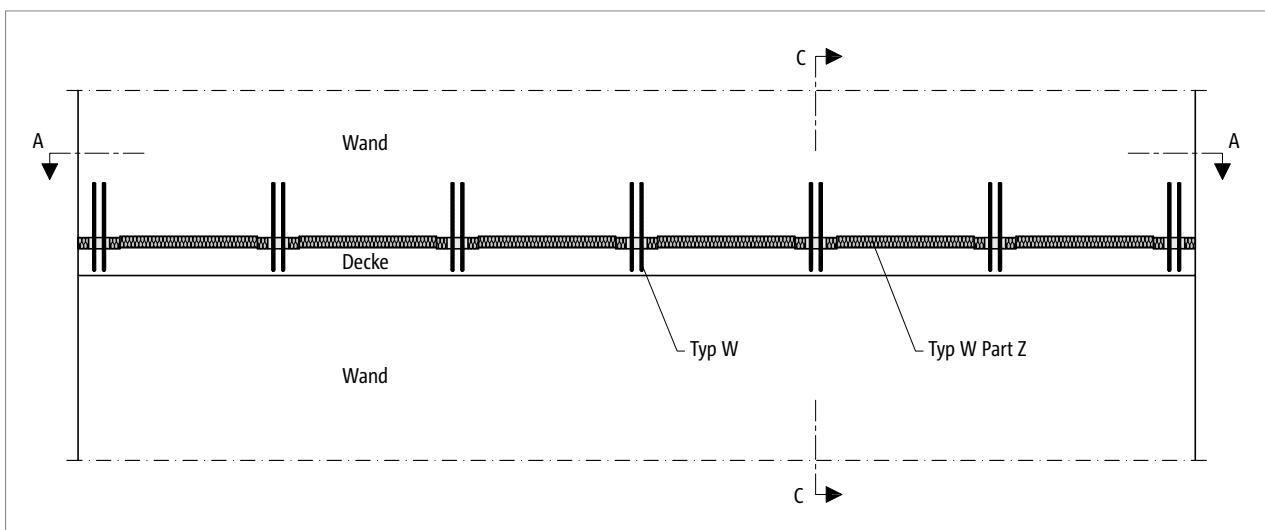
Schöck Sconnex® Typ W: Anschluss zwischen Decke und aufgehender Wand – Einbau am Wandfuß
